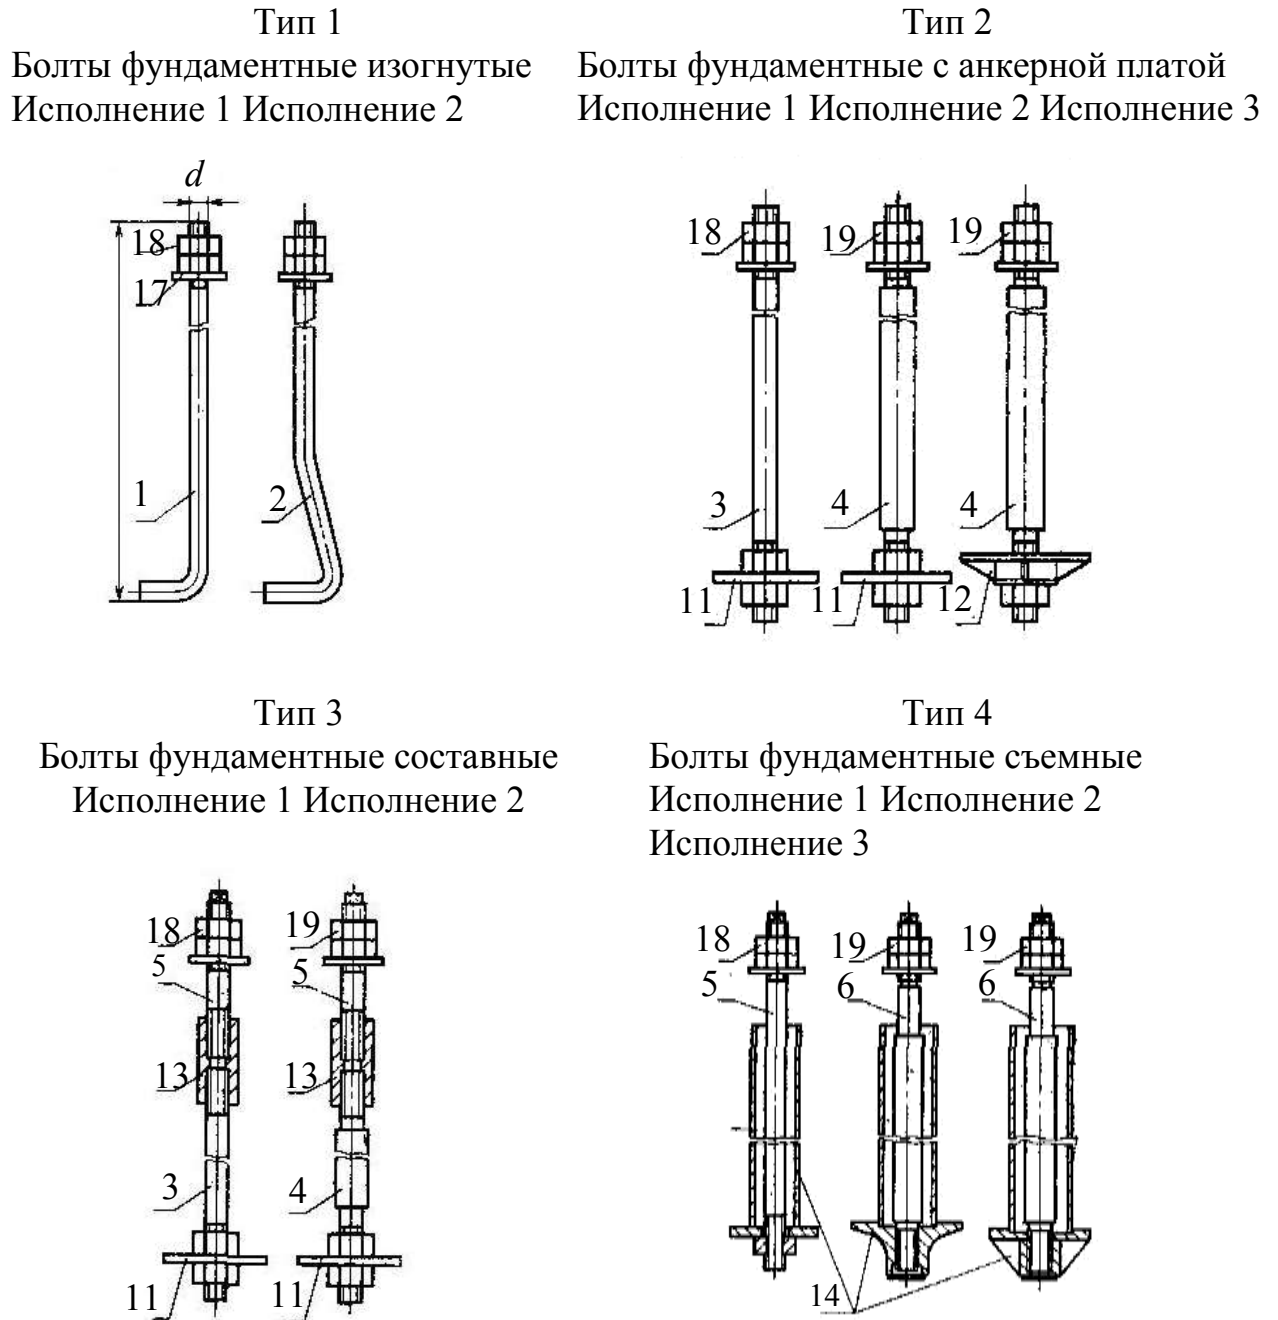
Типы и конструкции фундаментных болтов.
